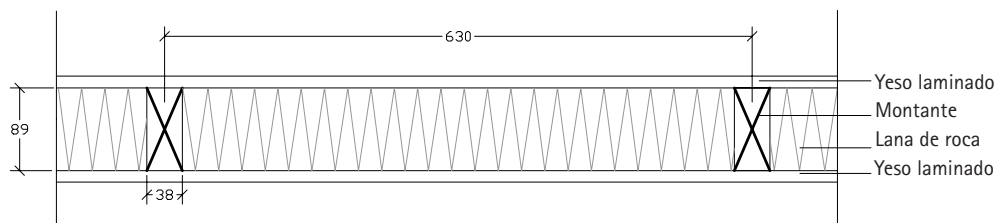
Vista en planta de la solución constructiva de tabiques (cotas en mm)
